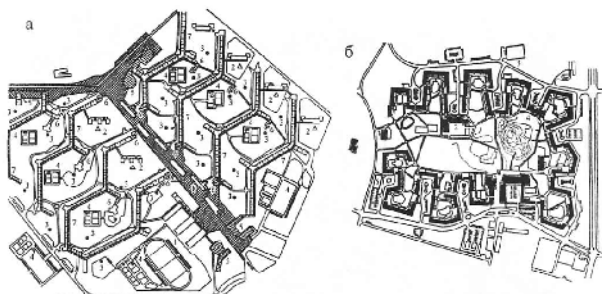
Схемы генеральных планов микрорайонов: а – генеральный план двух микрорайонов в жилом районе Ботанический в г. Красноуральске, Россия (проект); 1 – общеобразовательная школа; 2 – детские сады – ясли; 3 – площадки отдыха; 4 – спортивные площадки; 5 – общественные культурыно – бытовые центры; 6 – блоки первичного обслуживания; 7 – жилые дома, 8
